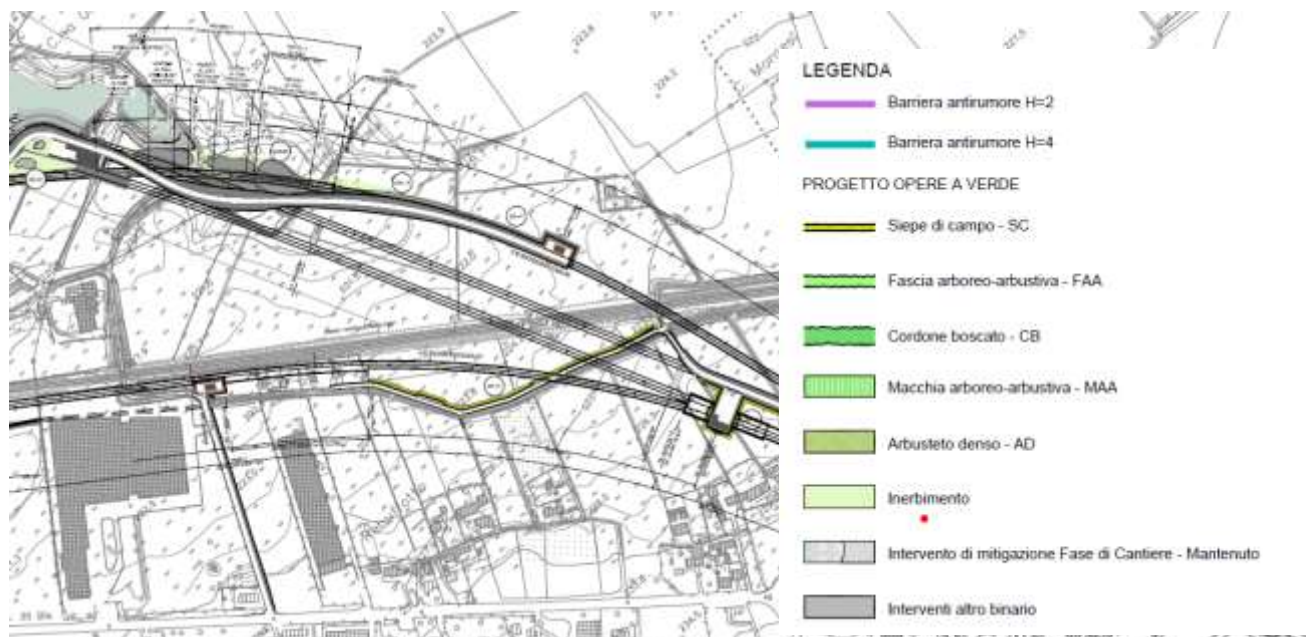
Progetto approvato – mitigazioni IAVA – Pianta
